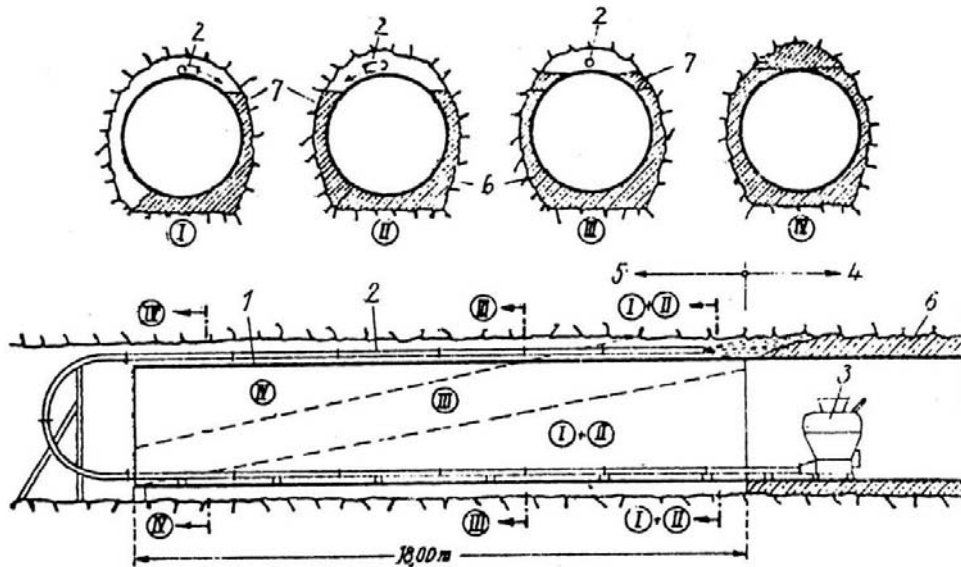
11 Betoniervorgang des Druckstollens [14]
